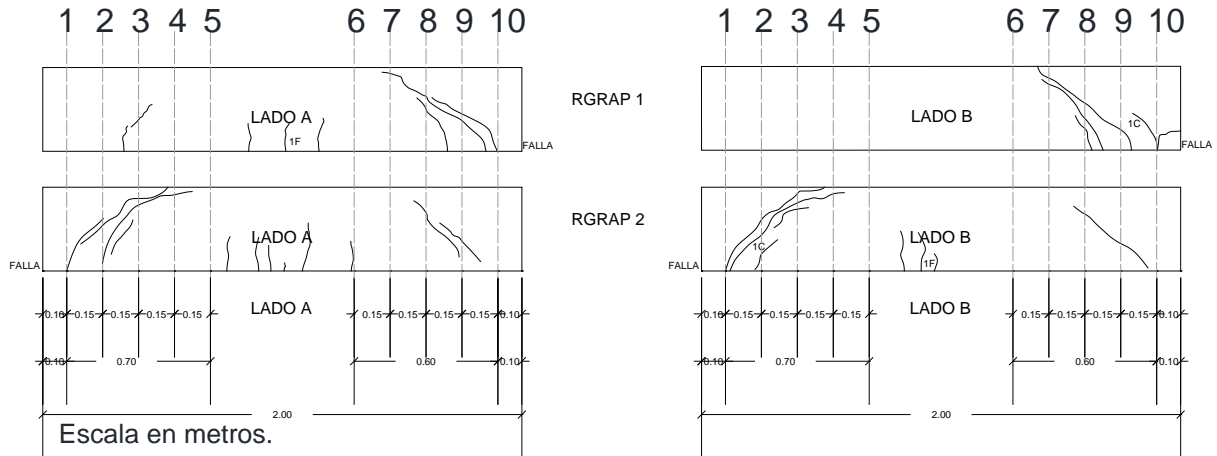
Patrón de agrietamiento en ambas caras de las vigas de control RGRAP ensayadas a flexión.
